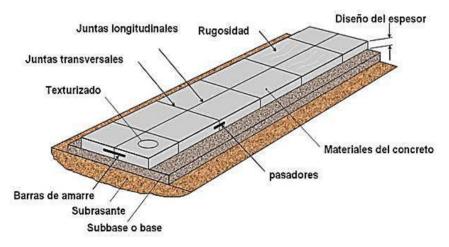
Diseño estructural de una losa de concreto para un pavimento rígido
